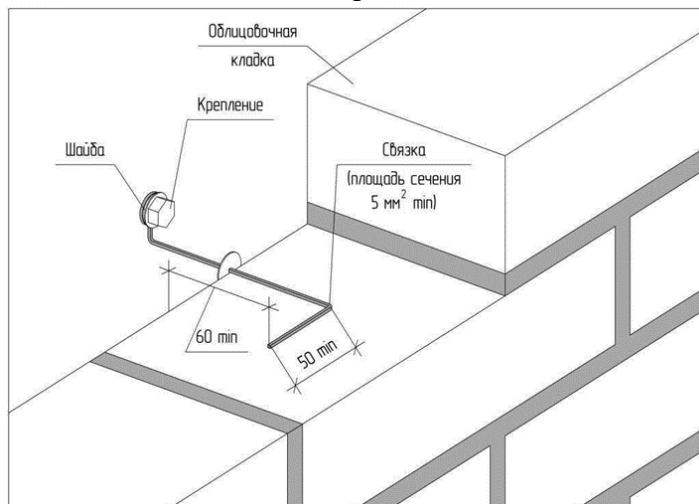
Схема устройства анкерной связки для крепления облицовочной кладки
